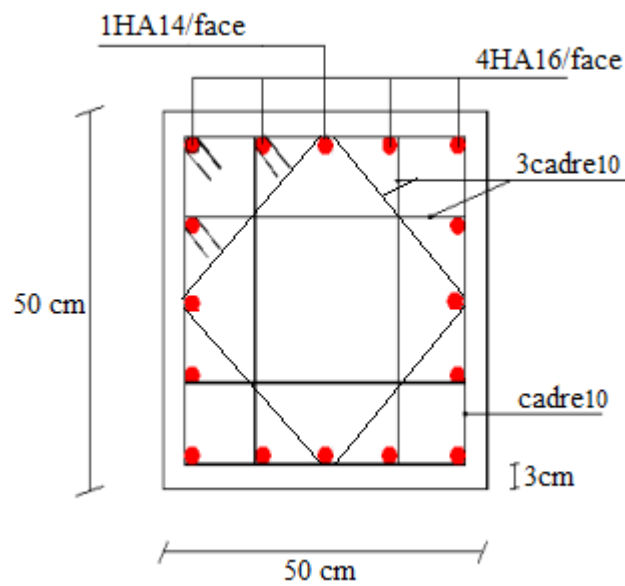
Schéma de ferraillage poteaux 4^{ème} étage+5^{ème} étage
